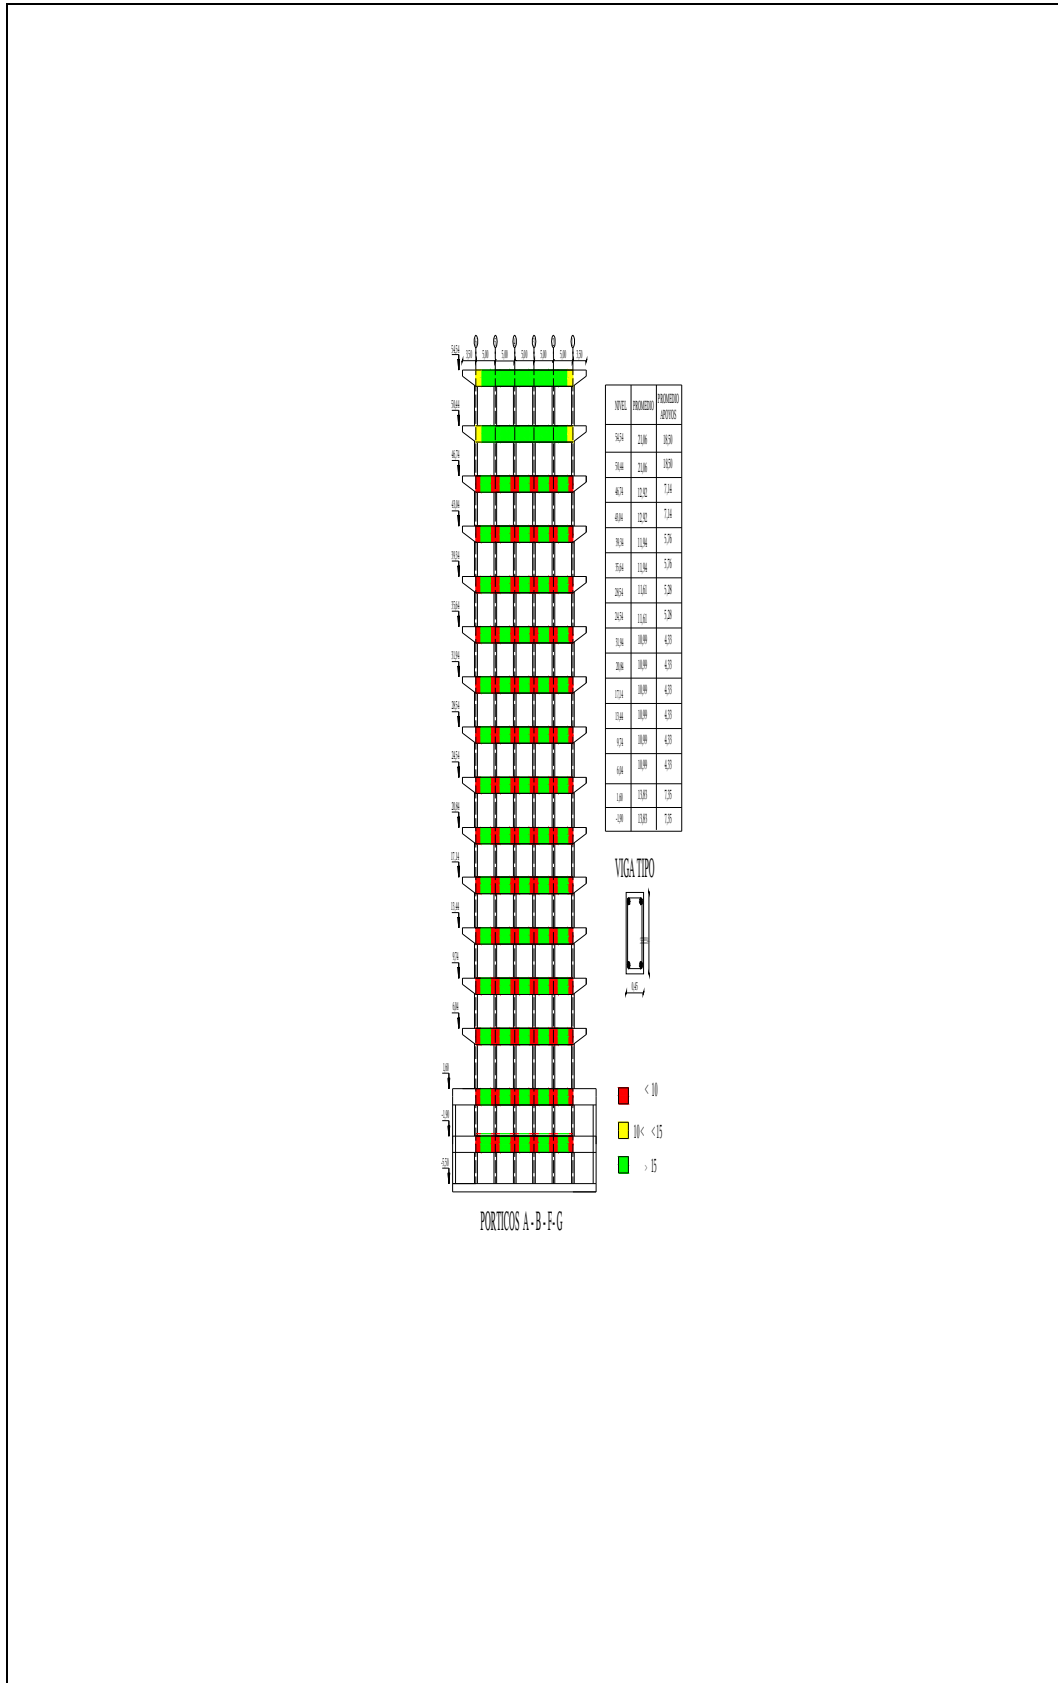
Capacidad de ductilidad por curvatura de las vigas de los pórticos A, B, F y G., de los bloques exteriores.
